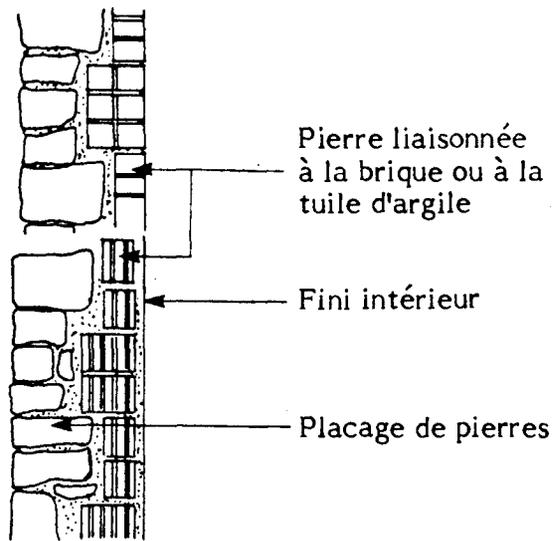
CONSTRUCTION D'UN MUR DE PLACAGE DE PIERRES
